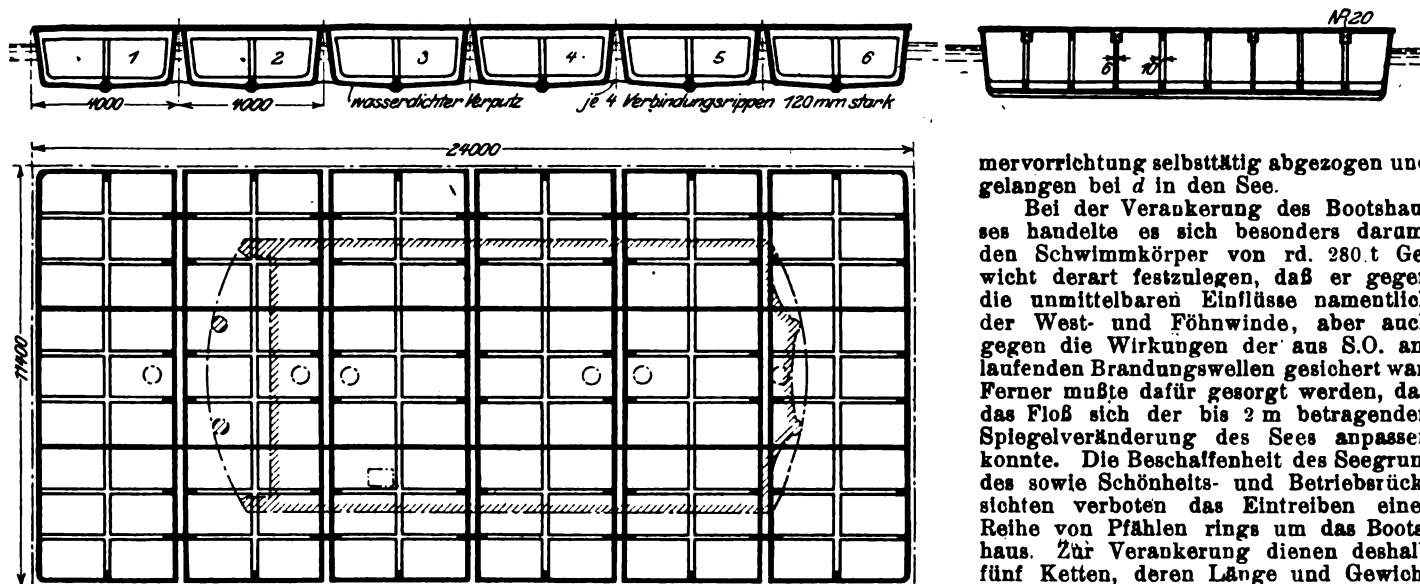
bis 3. Floß aus Eisenbeton. Maßstab 1 : 200.
